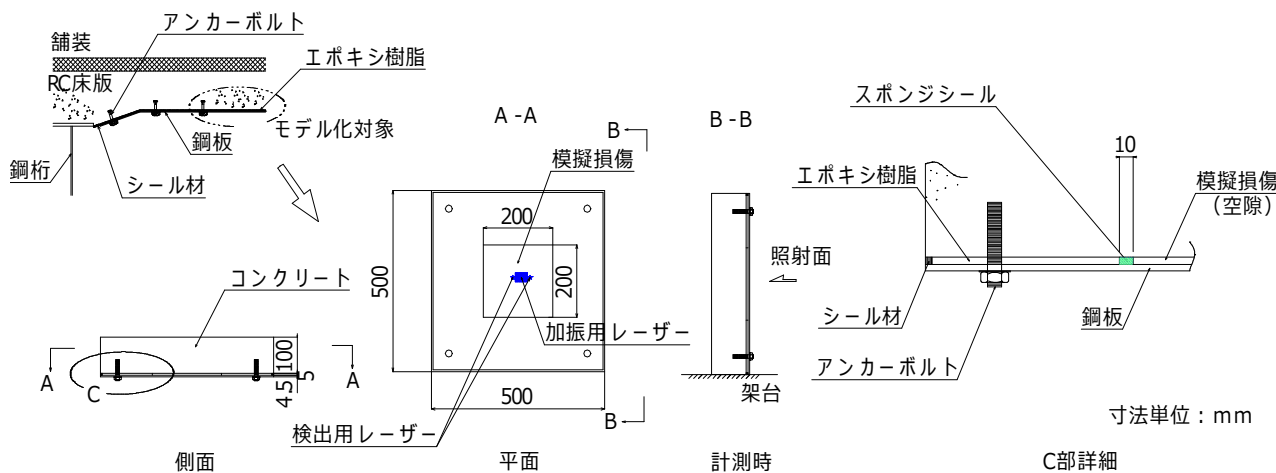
鋼板接着コンクリート床版をモデル化した模擬損傷試験体
